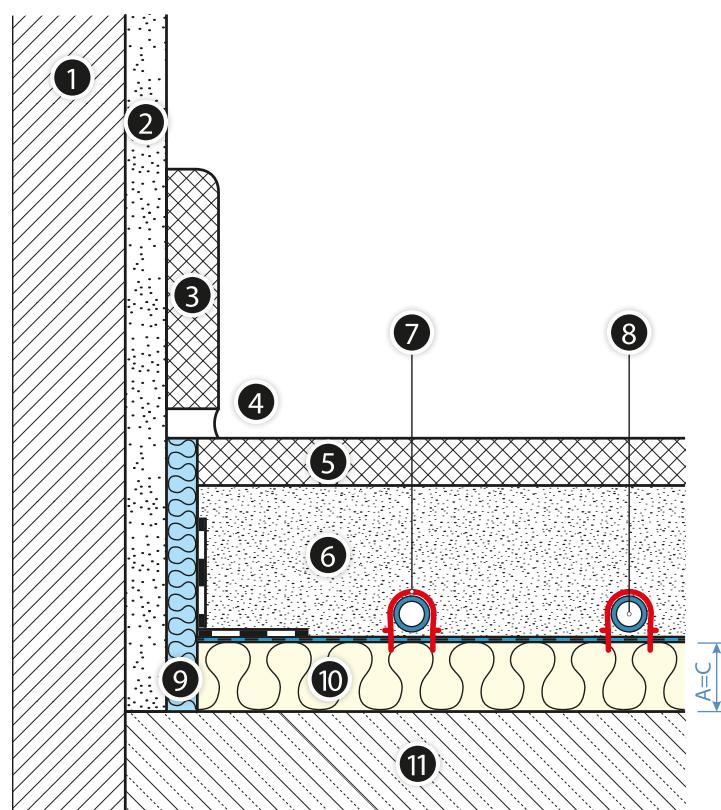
Напольный отопительный прибор с пенополистирольной плитой KAN-therm Tacker и дополнительной изоляцией на перекрытии над неотапливаемым внутренним помещением, а также перекрытием, контактирующим с наружным воздухом
